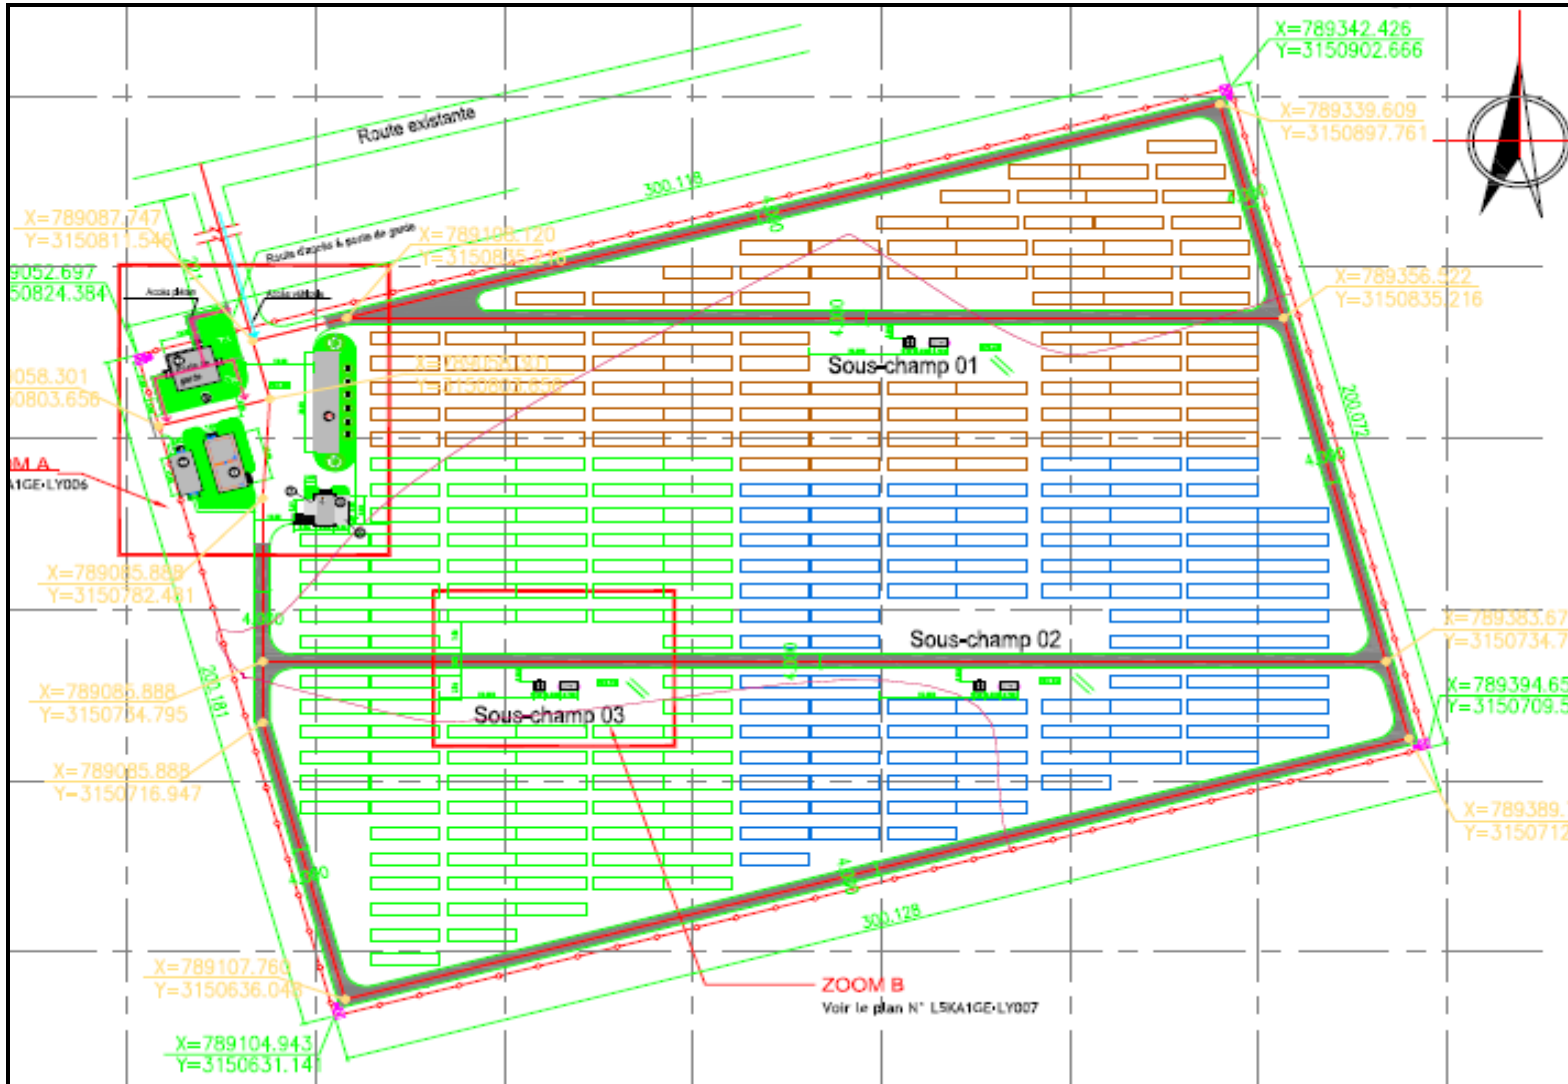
Plan de disposition des panneaux de la Centrale PV
